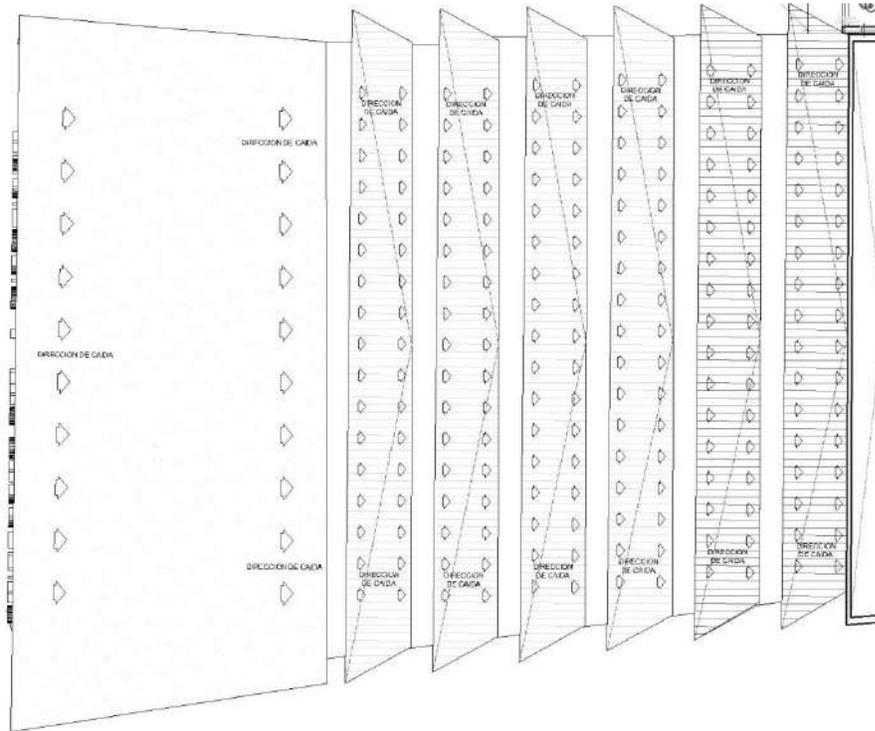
Plano de Techos – Ejemplar Zona de Auditorio:
